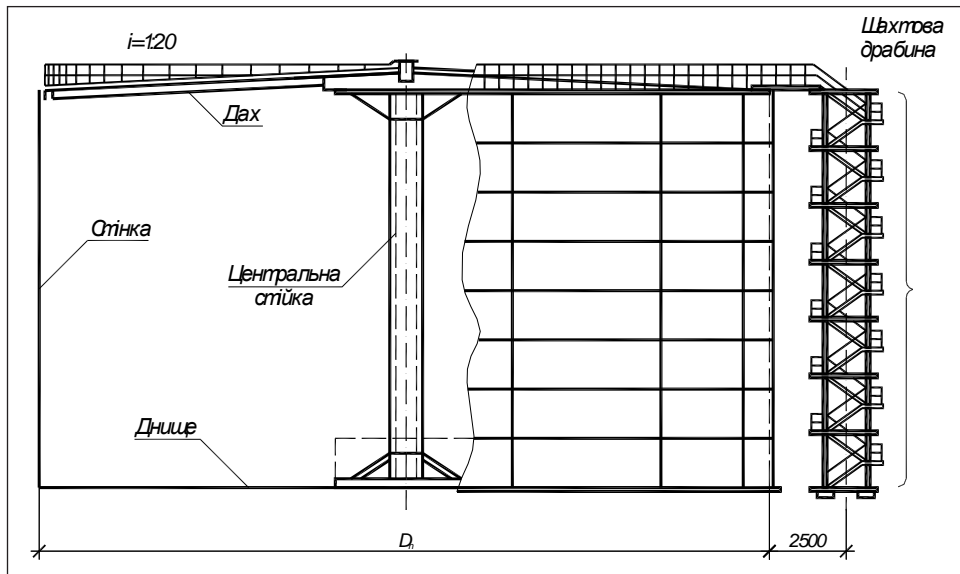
Фасад і розріз вертикального циліндричного резервуара
